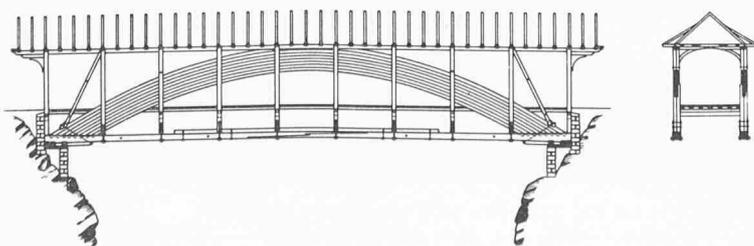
Fontannen-Brücke erbaut 1839 bis 1841, Bauart Wiebeking. Diese Brücke wurde im Jahre 1957 abgebrochen und im Rahmen des Ausbaus der Kantonsstrasse Romoos—Doppelschwand durch eine Betonkonstruktion ersetzt. Diese neue Brücke trägt den Namen Widigbrücke und steht unmittelbar neben den Widerlagern der alten Brücke.
